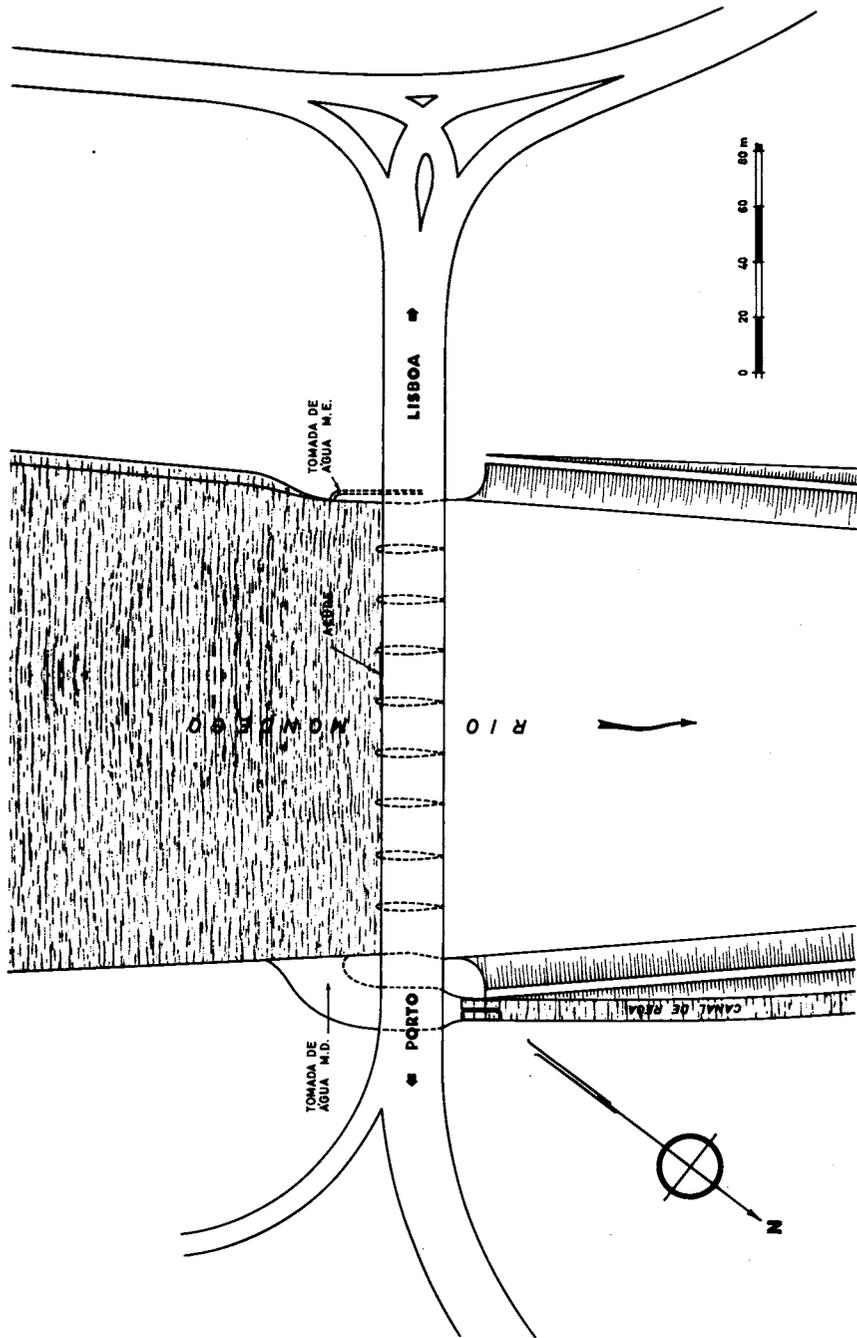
Planta do açude-ponte de Coimbra e respectivos acessos
